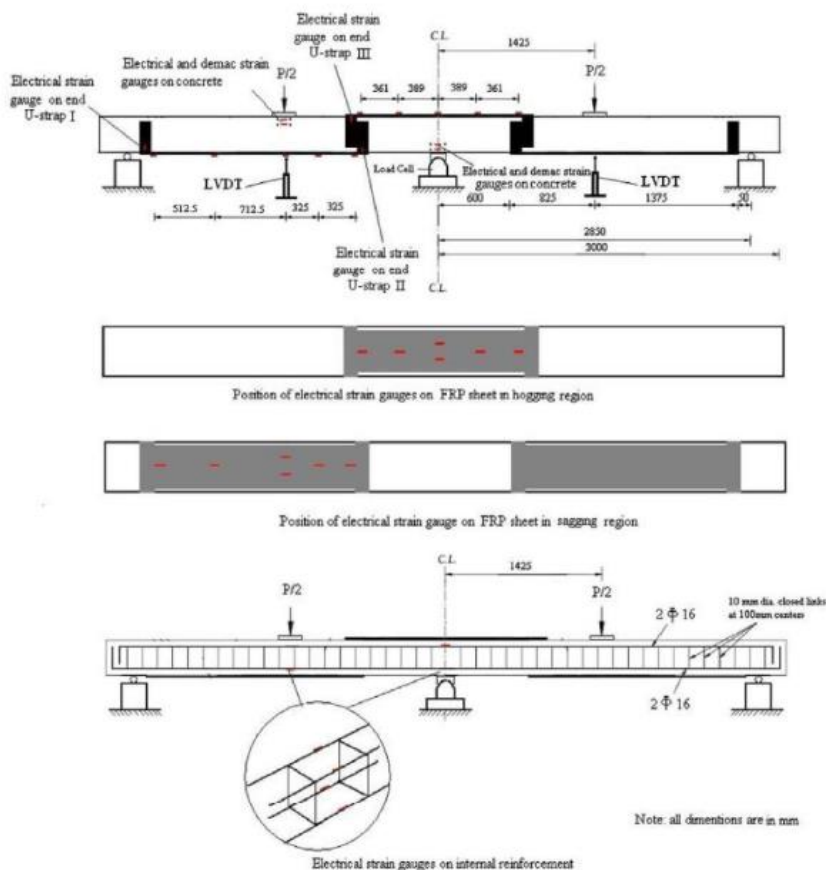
Испытательная установка и схема конструкции опытных образцов [129]
